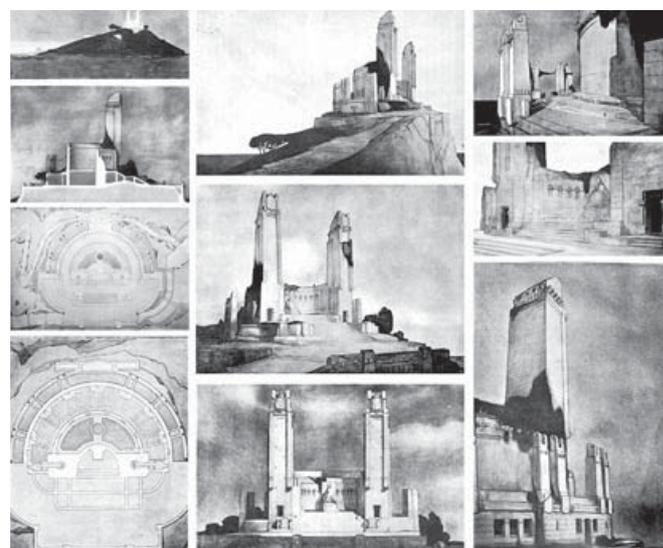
Monumento y Asilo dedicado a S. M. la Reina Doña María Cristina. Izquierda: Efecto de noche, Sección, Planta baja y Planta principal. Centro: Perspectiva lateral, Vista General y Alzado. Derecha: Detalle de la exedra, Detalle de terraza posterior y Detalle posterior de una de las torres. Dibujos de T. Anasagasti, 1913
